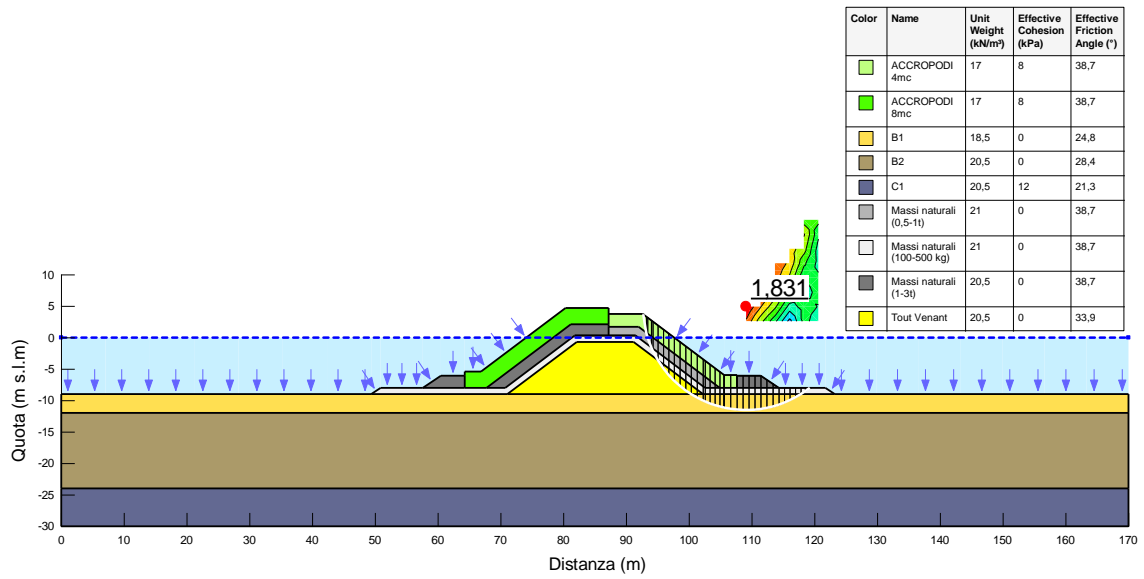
Sezione B – SLU-GEO 2– Superficie critica destra
